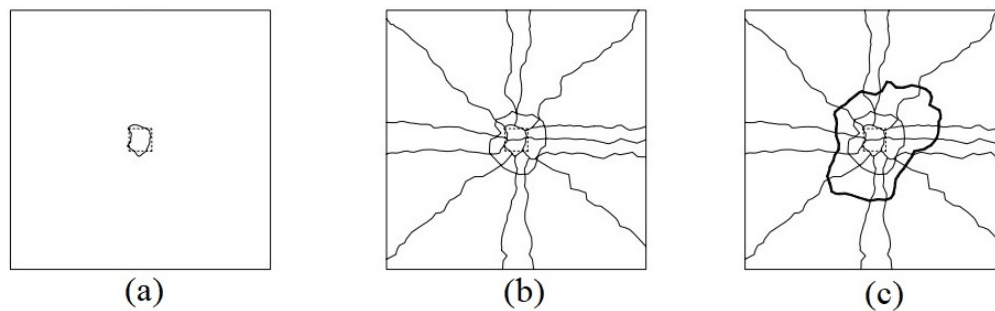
Fissuras para cargas (a) baixas, (b) intermediárias e (c) altas na falha por punção (fonte: Guandalini (2005))
